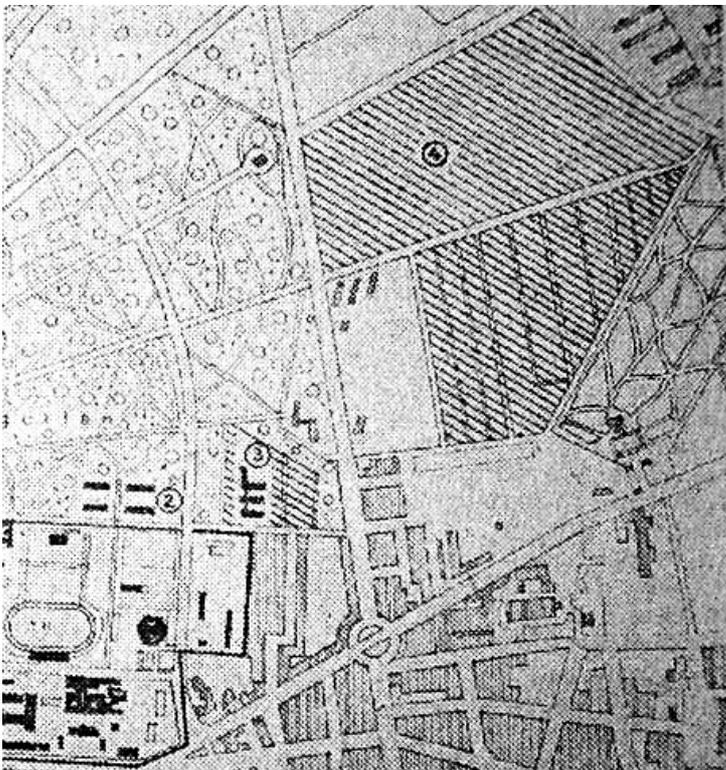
Plan der Architekten Brunisch und Platz [Quelle: B.N.N. 12.12.1956]
